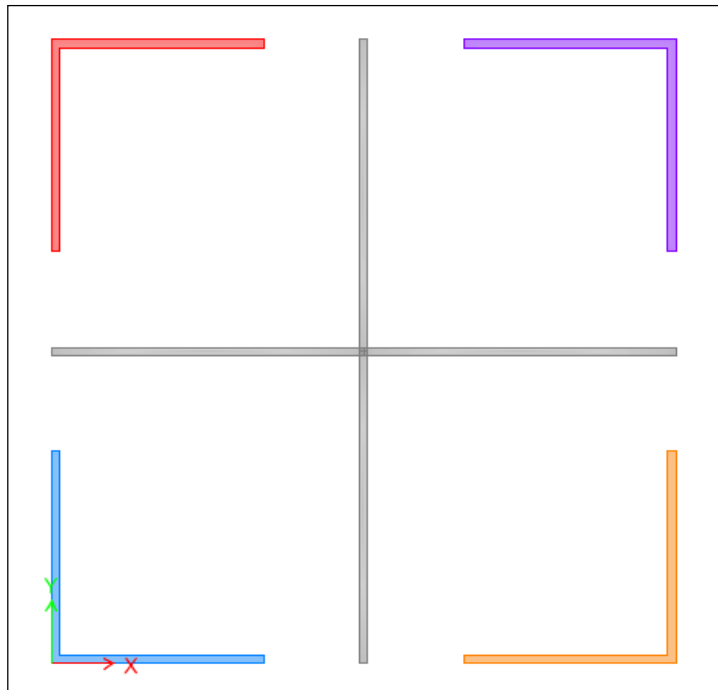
Vista en planta del Edificio C (elementos tipo barra de sección transversal irregular)
